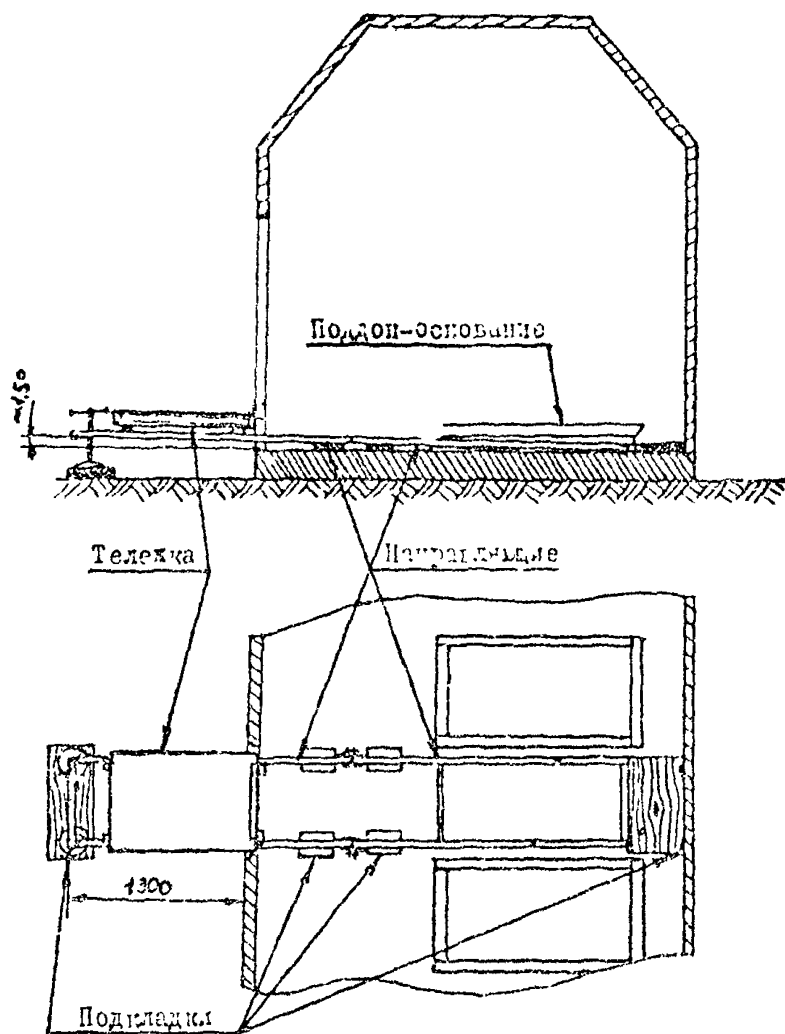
Схема расположения приспособлений при установке агрегатов типа ДГА-16 с помощью тележки и направляющих
